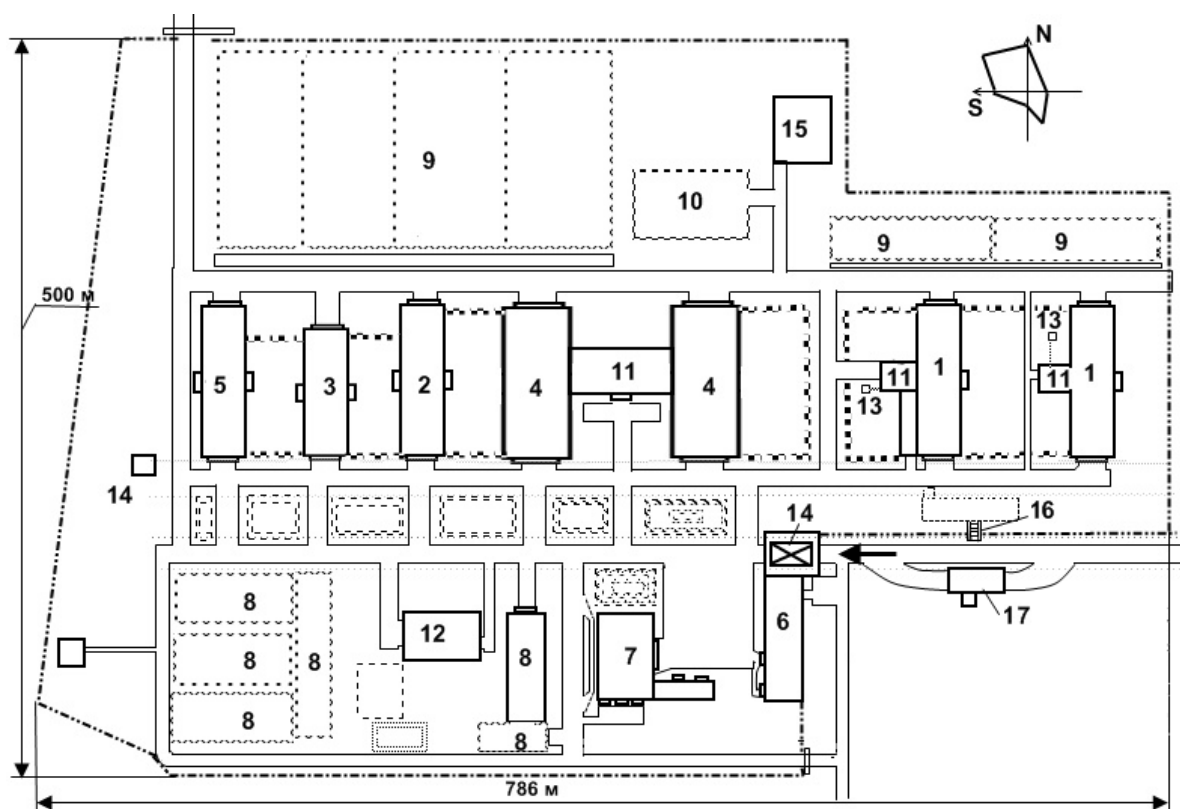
Схема генерального плану ферми з однорядним розміщенням тваринницьких приміщень та централізованою системою забезпеченням водою:
